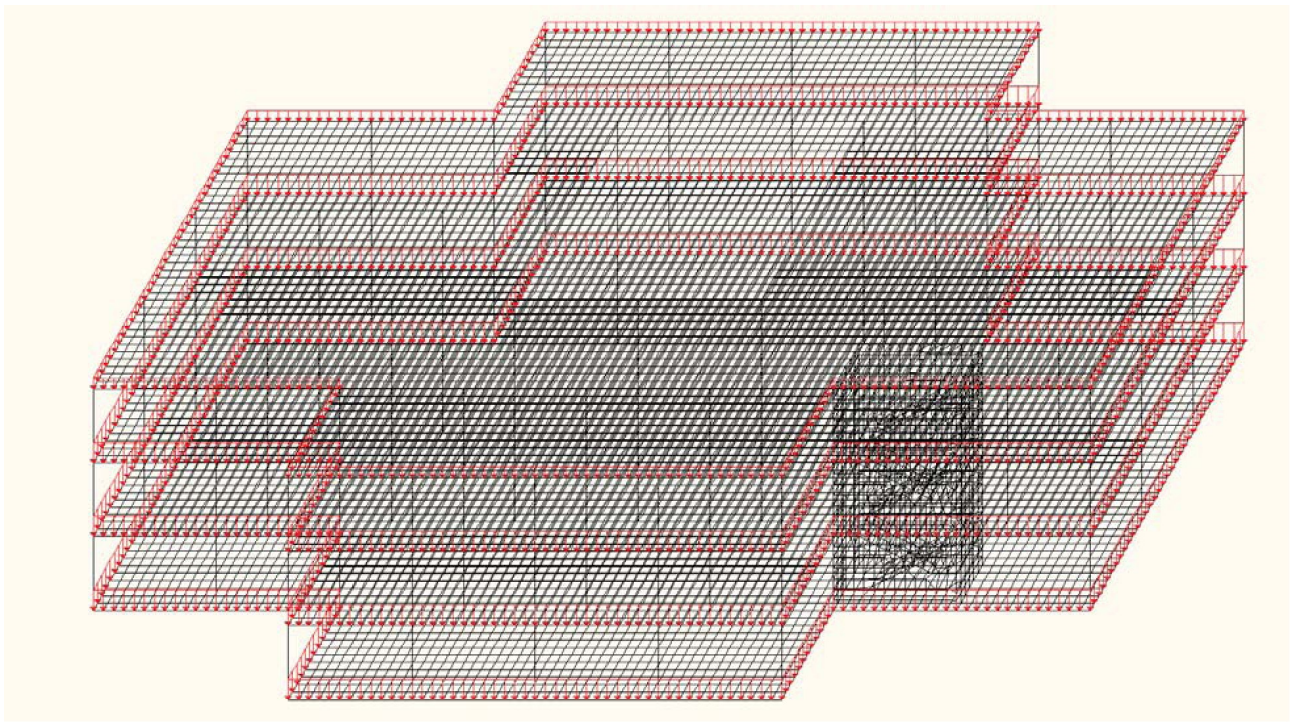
Схеми завантажень будівлі від ваги огорожувальних конструкцій
